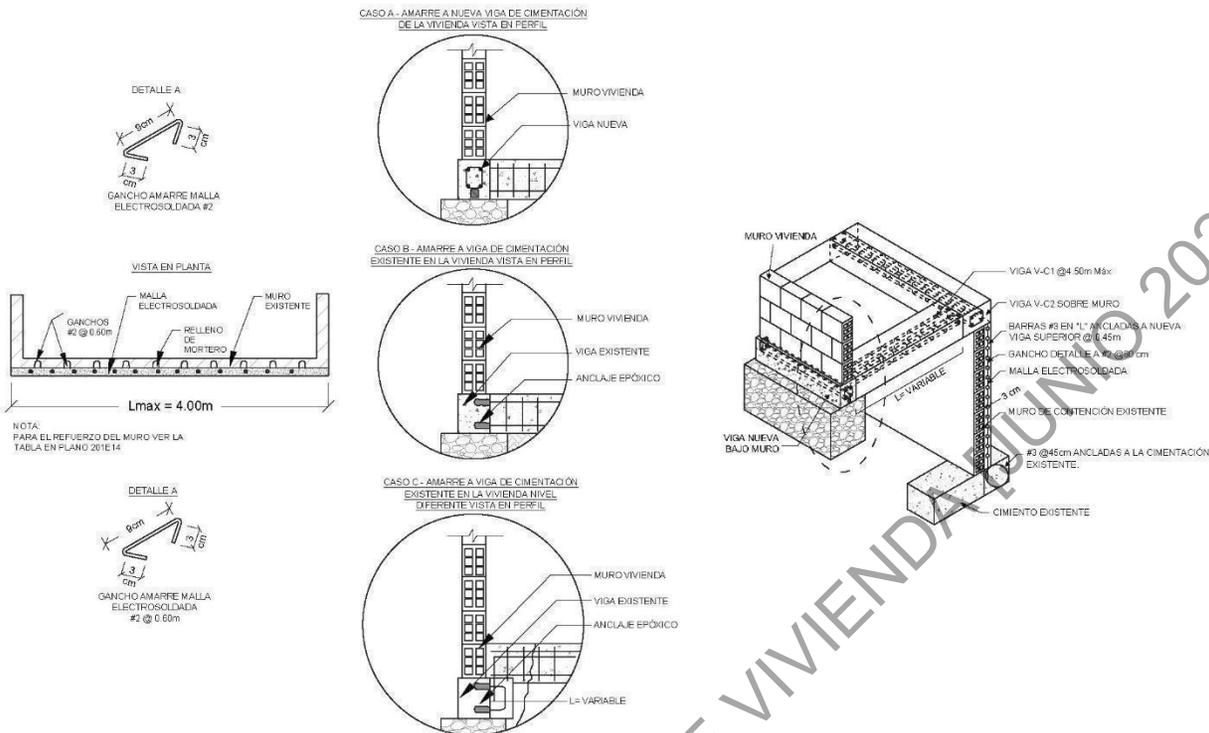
Refuerzo de muro de contención de cimentación.
